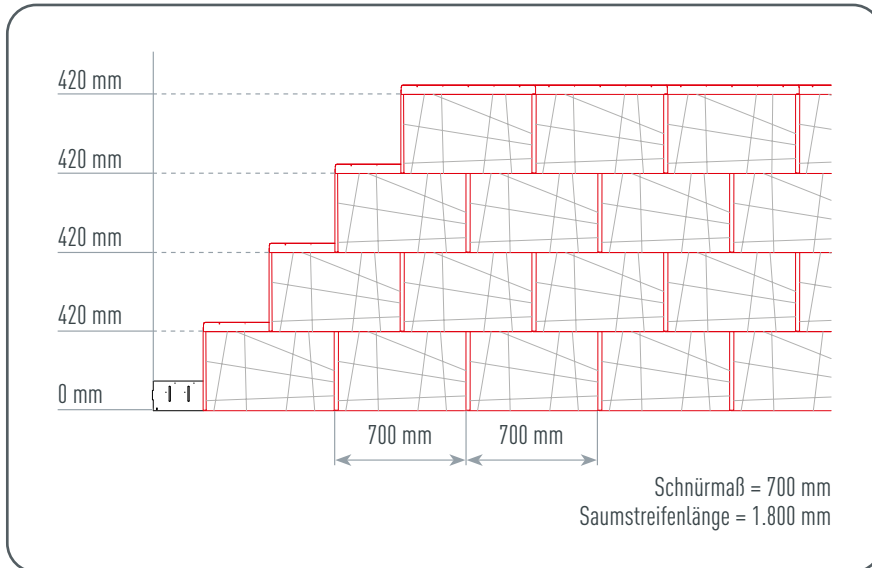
· Fassadenpaneel FX.12 – Schnürmaß
